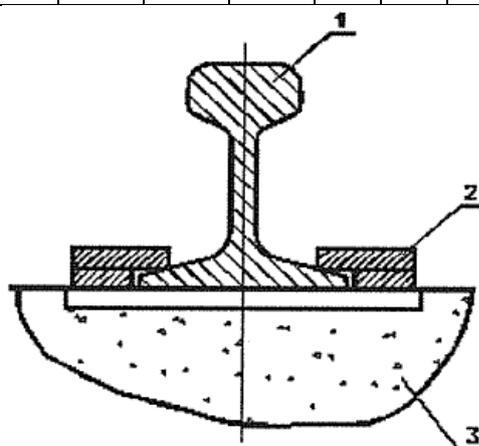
Конструкция промежуточных креплений. 1 – направляющая, 2 – прижим, 3 – железобетонный опорный элемент.
